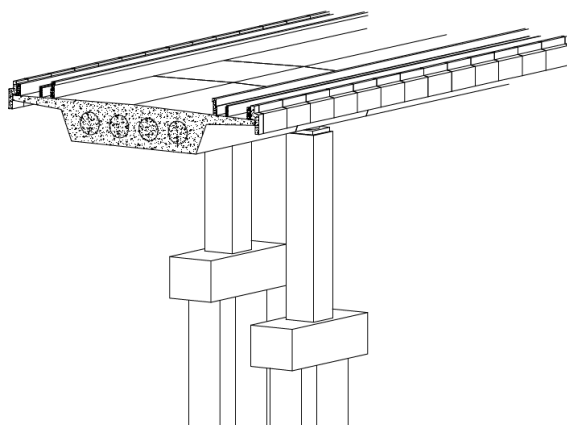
Vista de um alinhamento de pilares correntes (imagem retirada do modelo BIM)
